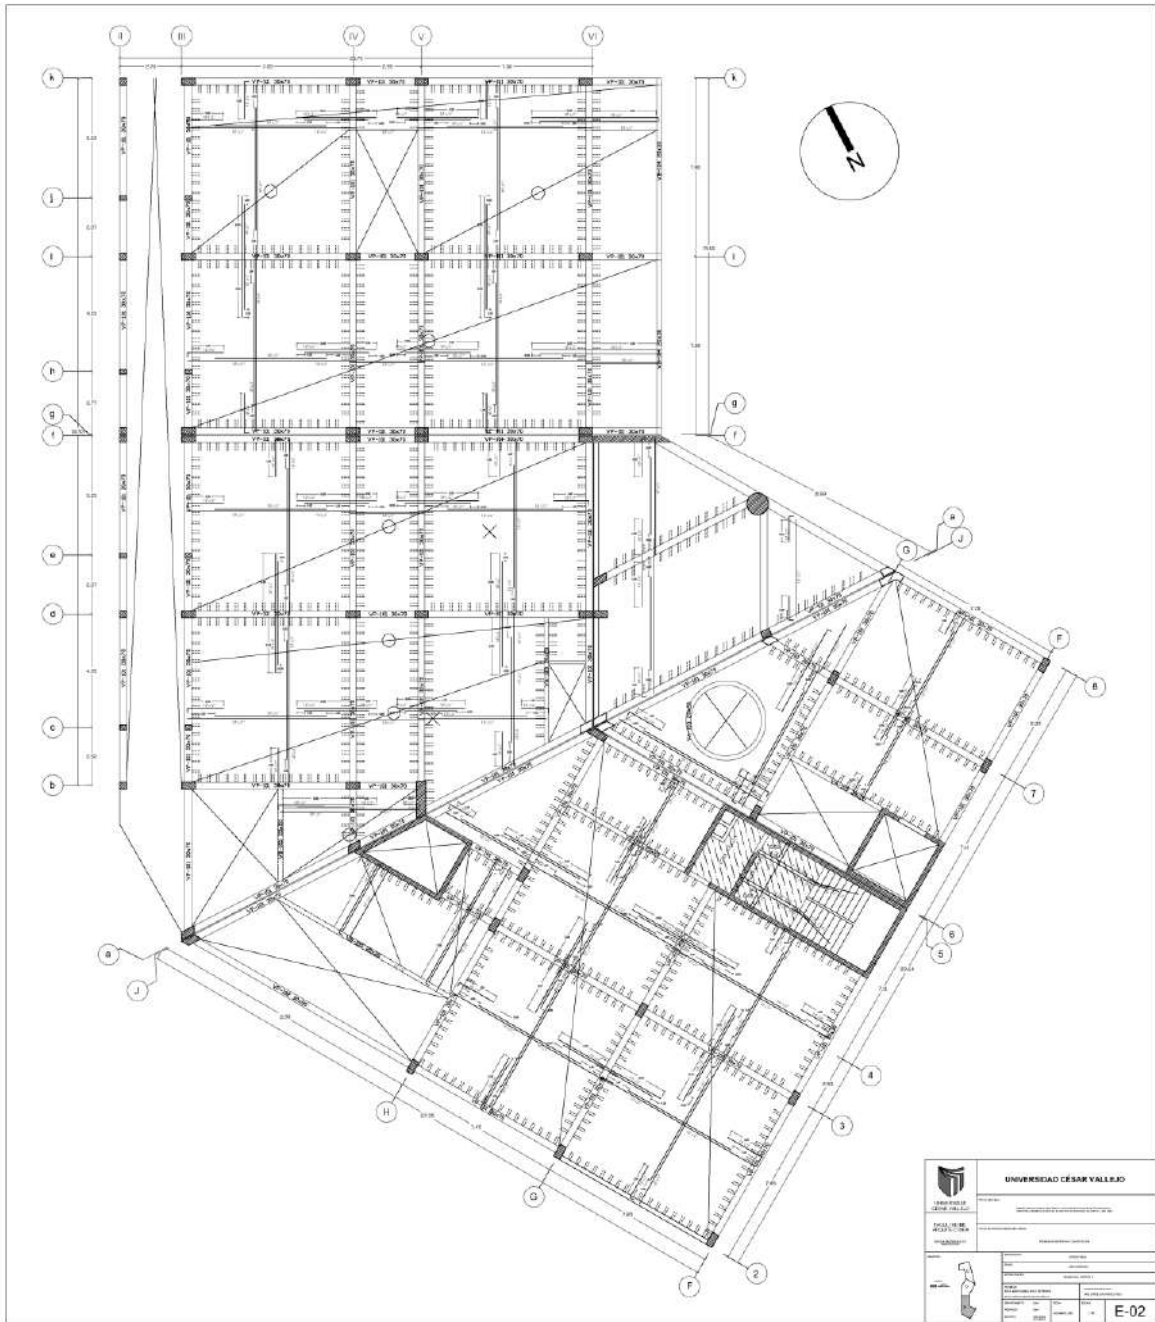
Aligerado - Primer piso sector B - ESTRUCTURAS
